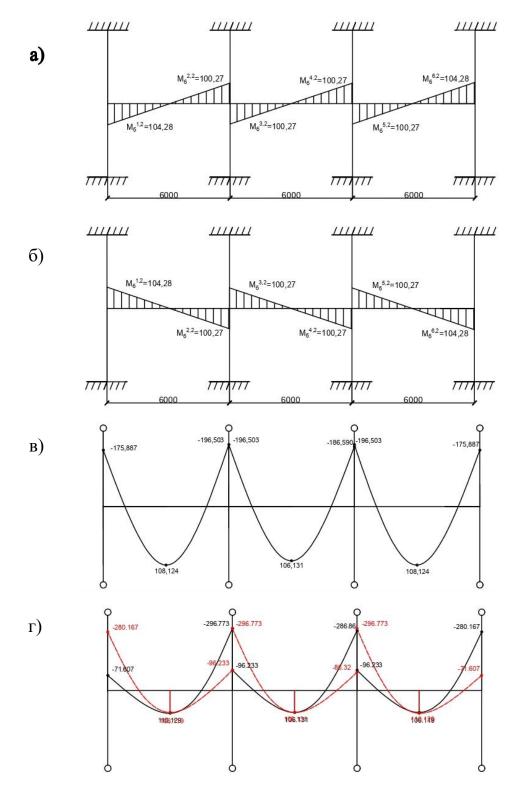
Эпюры изгибающих моментов от знакопеременной ветровой нагрузки (а,б), огибающая эпюра моментов от вертикальной нагрузки(в) и суммарная эпюра сочетаний моментов от горизонтальных и вертикальных нагрузок(г) для 9-ти этажной рамы
